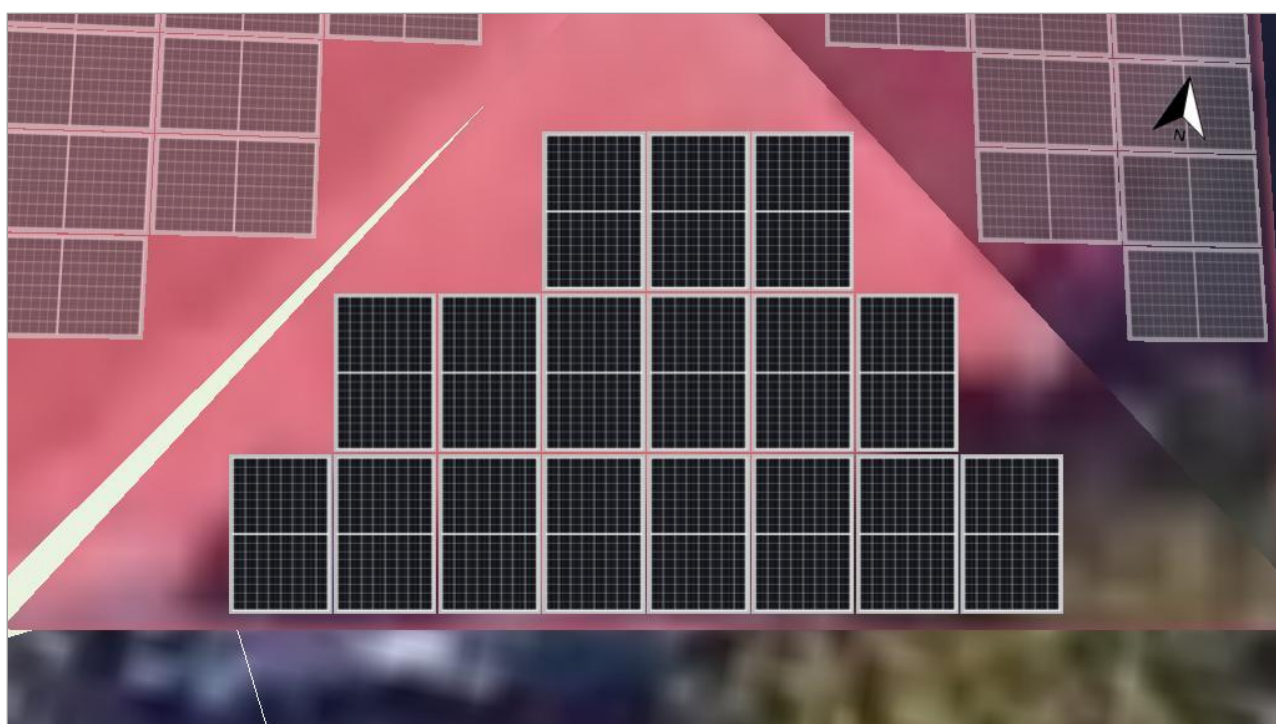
Zona modulului - Arbitrary Building 06-Mounting Surface South
